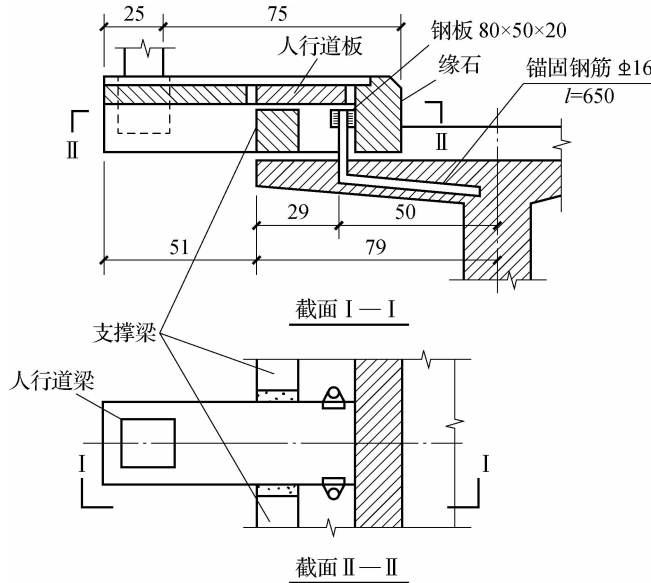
悬出的装配式人行道构造(尺寸单位:cm,钢筋/钢板单位:mm)
